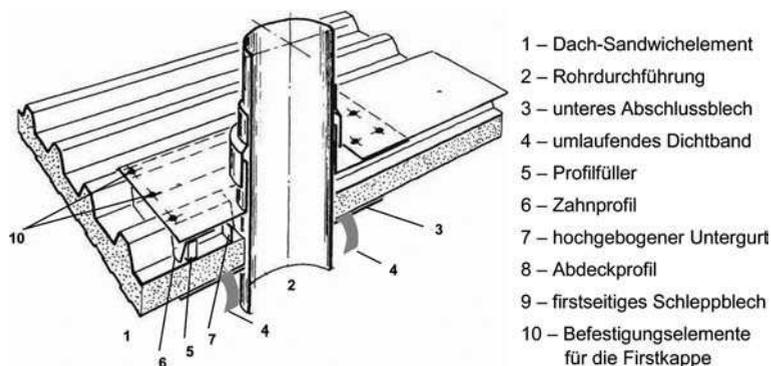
Abdeckung an Rohrdurchführungen bei Deckungen mit Sandwichelementen
